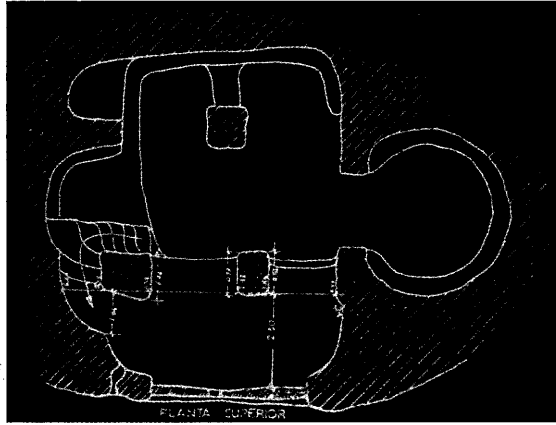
Planta de Arroyuelos (Valderredible, Cantabria)
